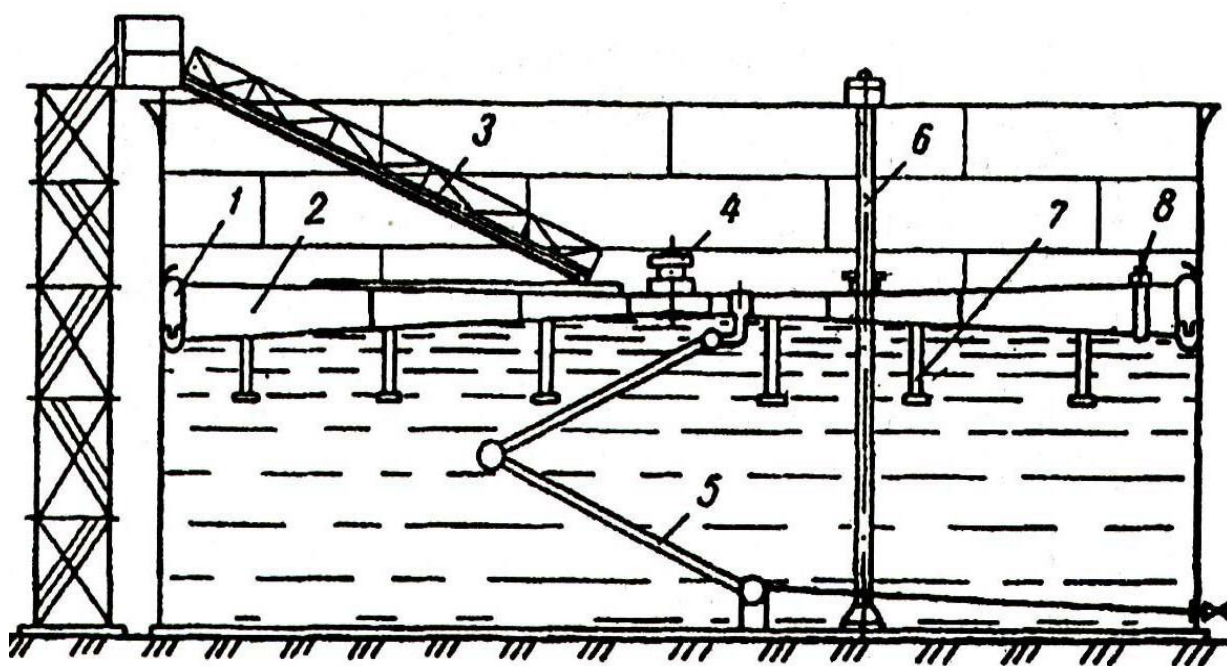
Общий вид резервуара с плавающей крышей:
